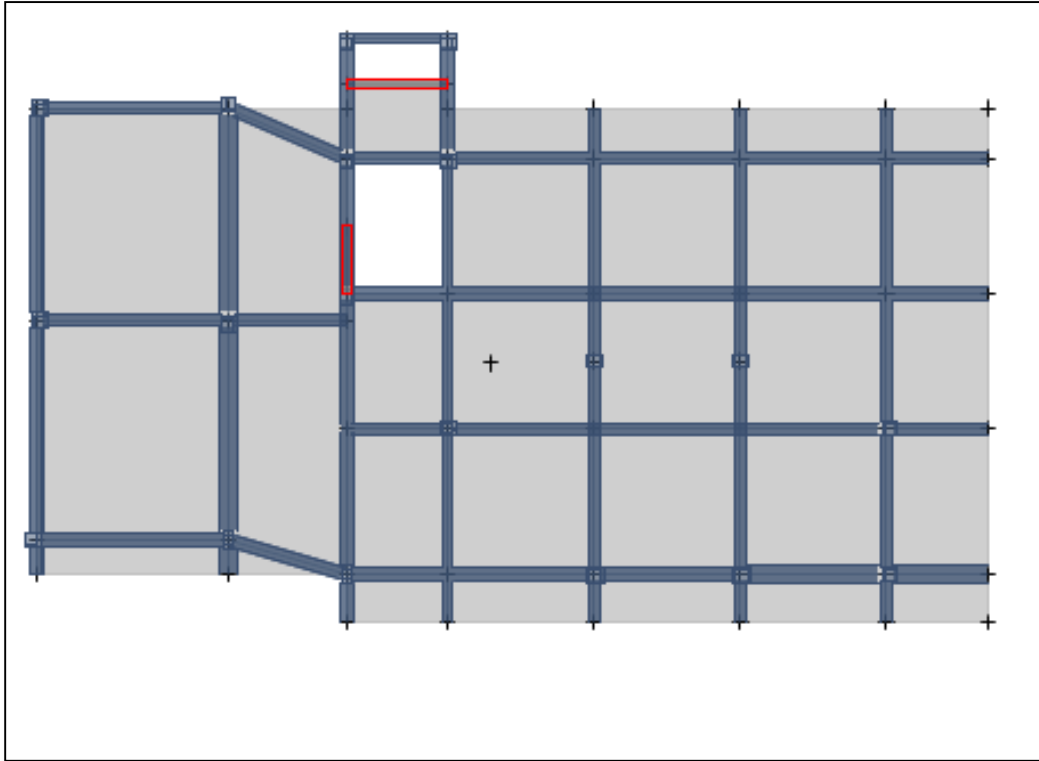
Planta N+4.95 Estructura 5.2 Hotel
